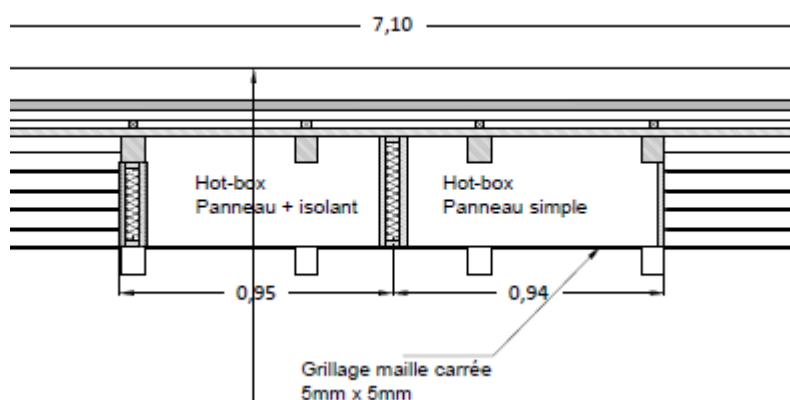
plan en vue latérale de la hotbox (Source : CD54)
